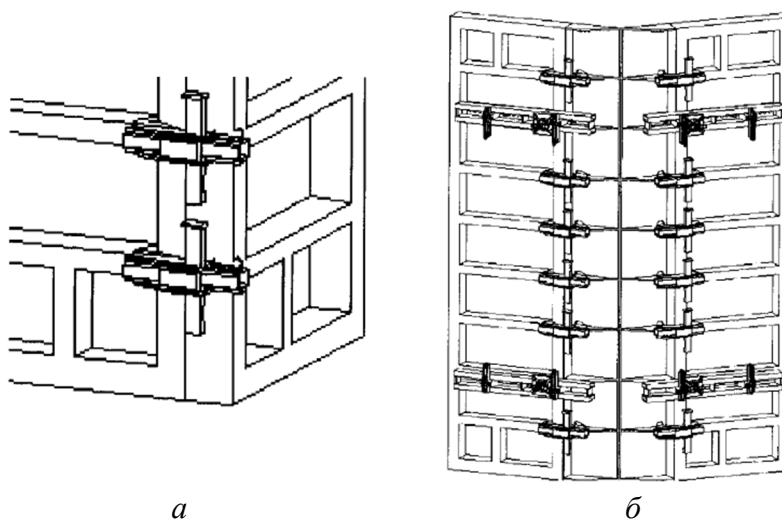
Установка замков: а – в угловом соединении внахлест; б – при шарнирном соединении опалубочных щитов
